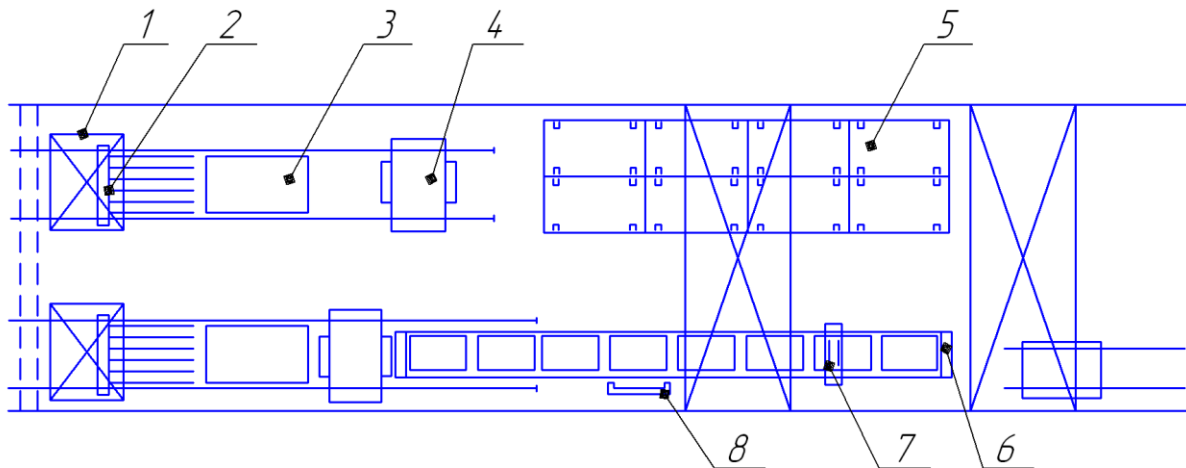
Полуконвейерная линия по производству многопустотных плит перекрытия:
